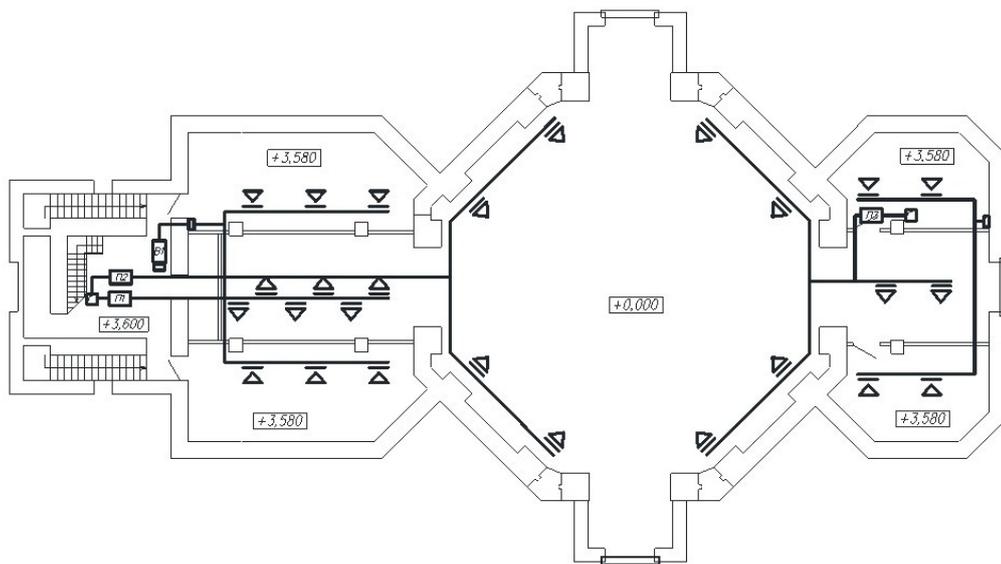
План на отм. –2.700 с радиаторным отоплением, совмещенным с воздушным отоплением
